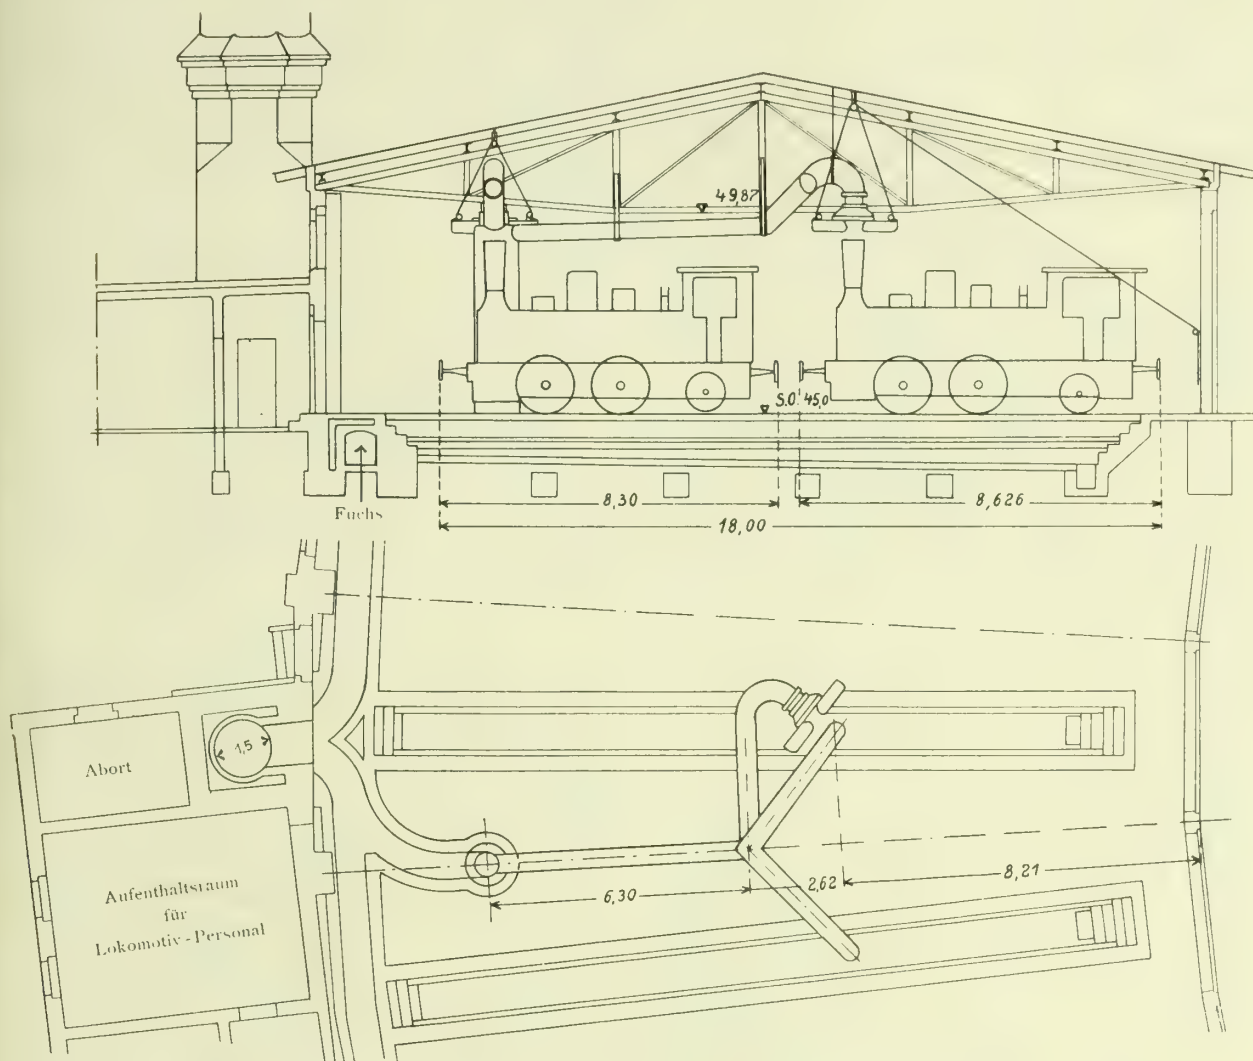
u. 10b. — Grundriss und Aufriss der Rauchleitungen für Tenderlokomotiven
